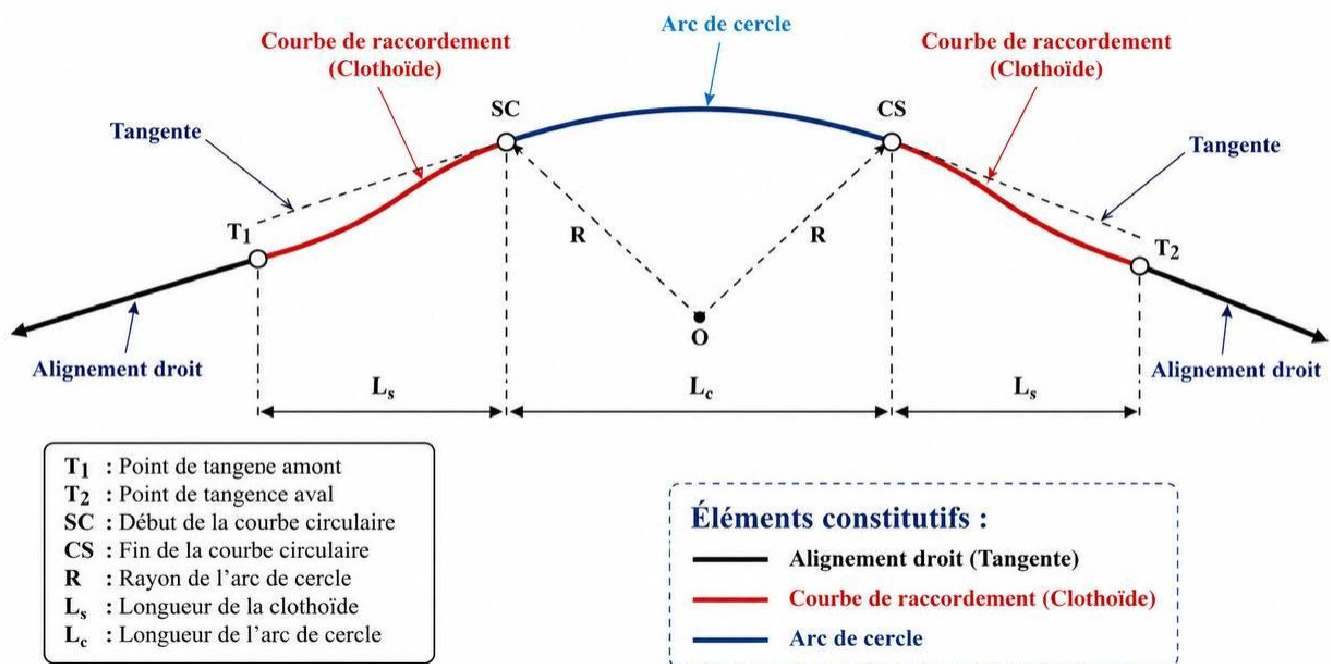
Éléments constitutifs d'un tracé en plan.
